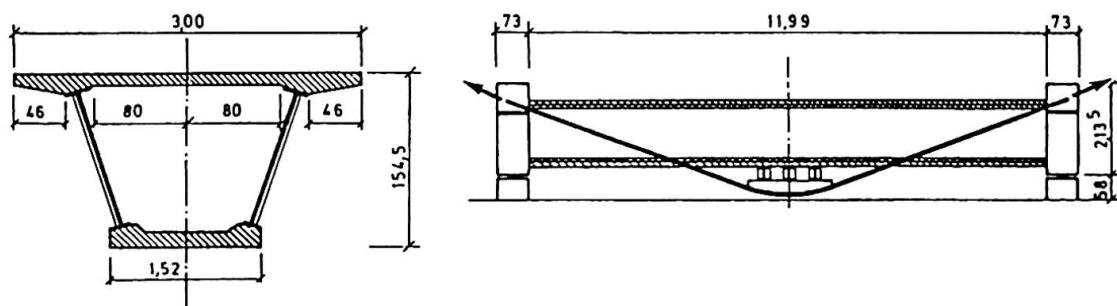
Schéma de la maquette d'essai d'Asnières.
